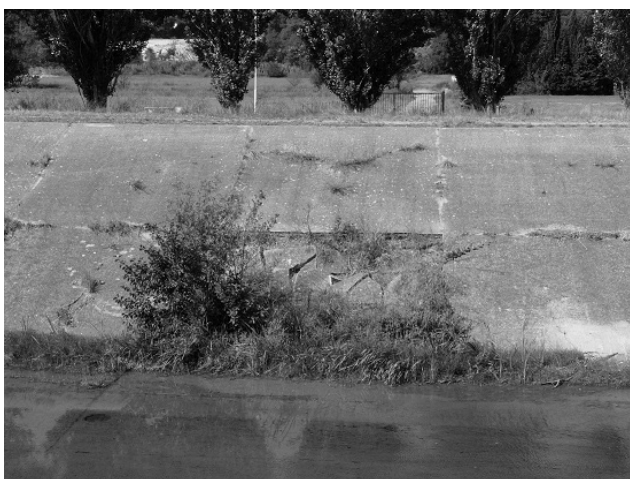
DÉVELOPPEMENT DE LA VÉGÉTATION EN PIED DE DIGUE ET FISSURATION DE LA DALLE SUPÉRIEURE À MI-HAUTEUR
